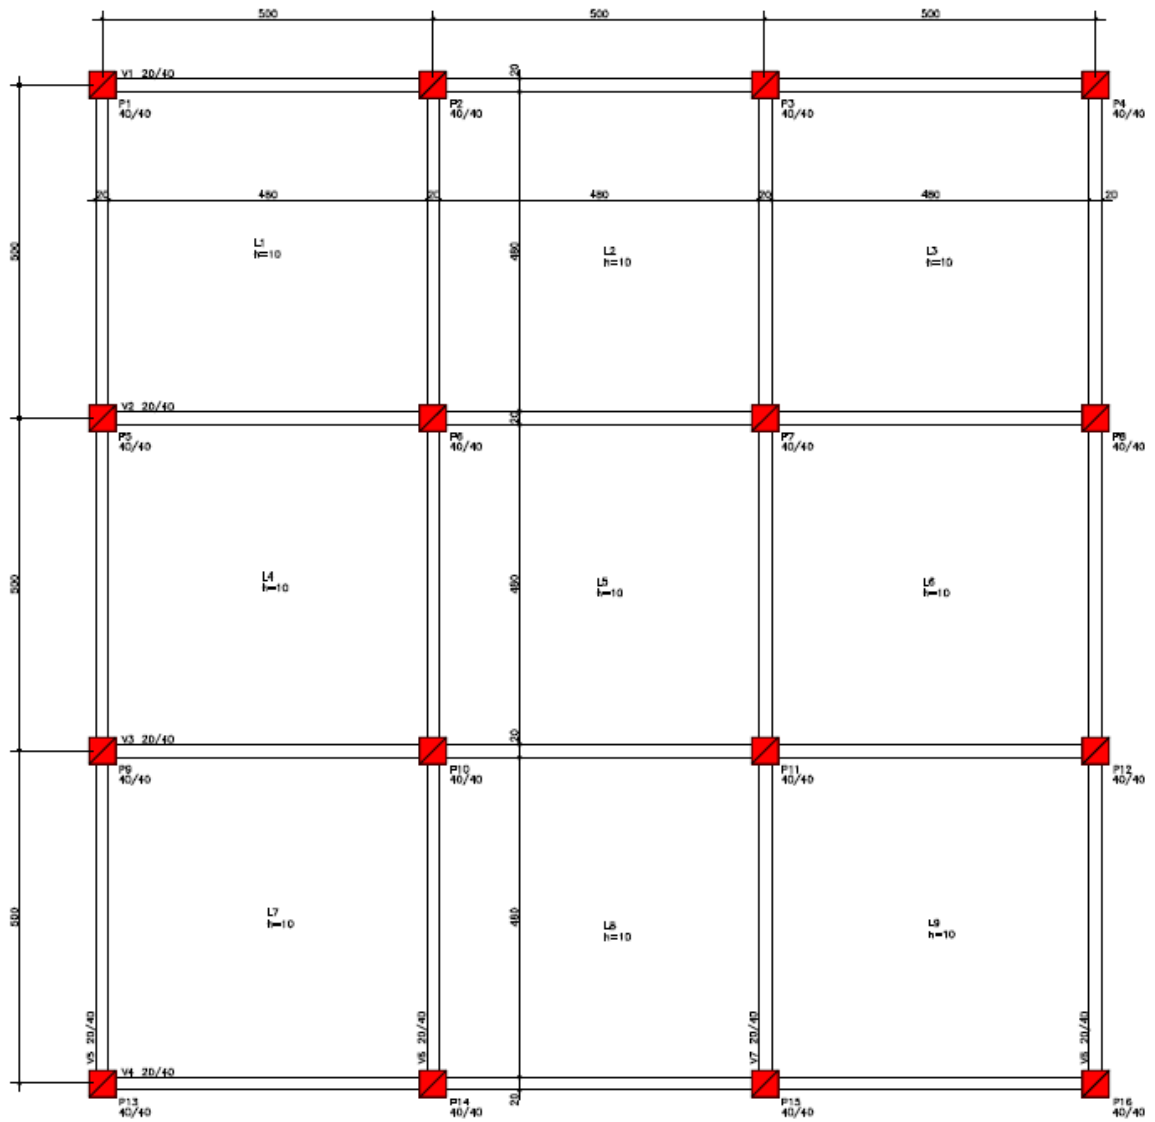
Forma do Pavimento Tipo – Exemplo A (fonte: Oliveira, 2009)
